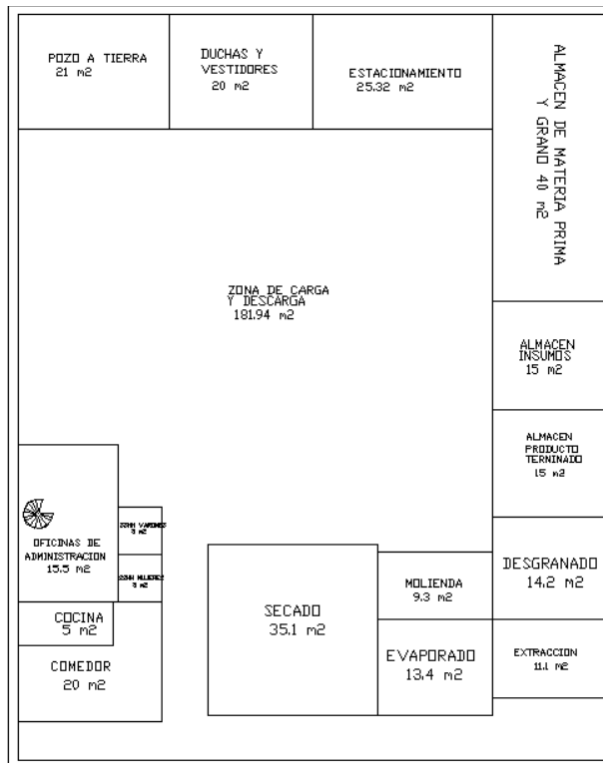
FIGURA III: PLANO ÁREAS SEGUNDO PISO
